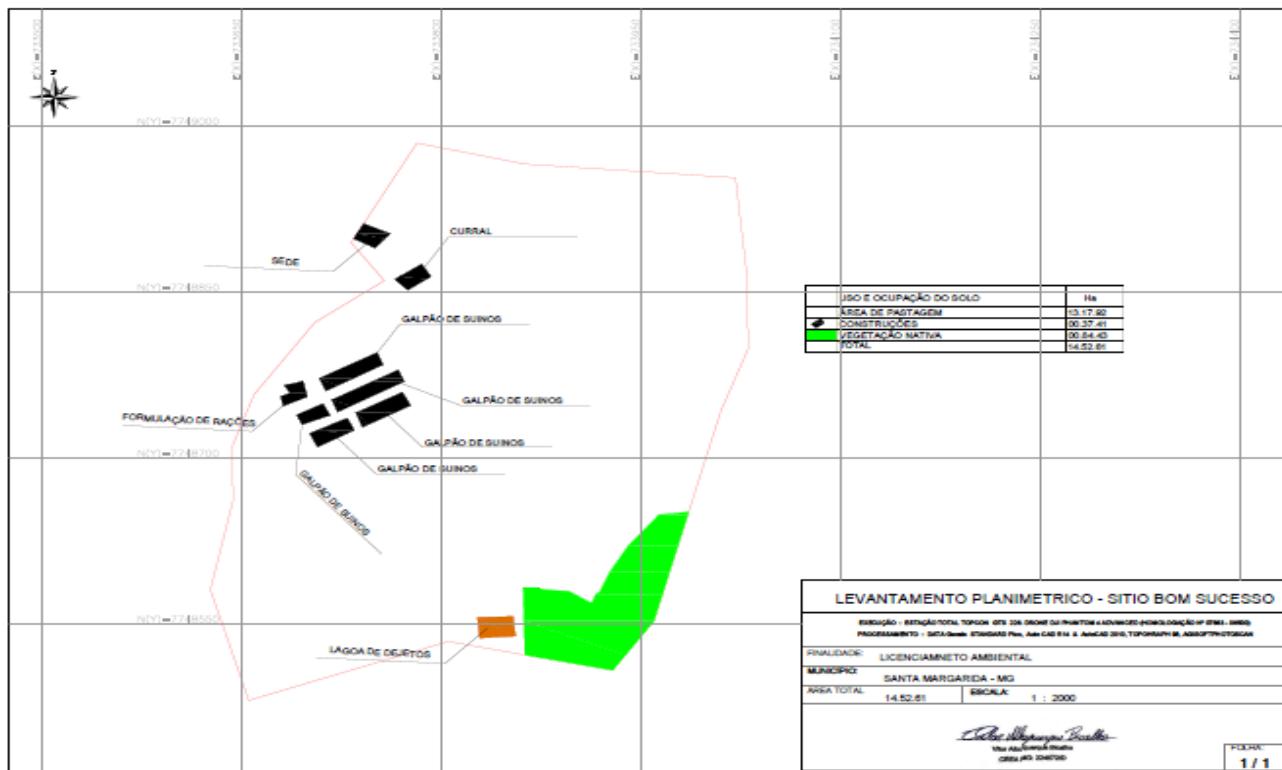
Planta planimétrica de situação da propriedade. (fonte: RAS, pag. 141/141)
